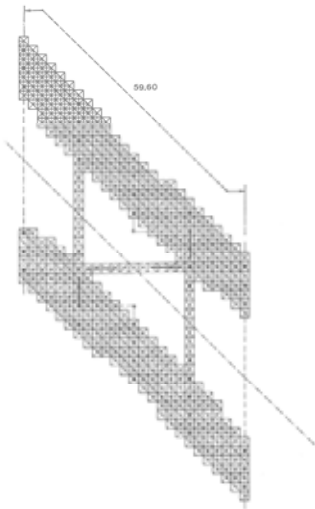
(dcha.). Planta de situación. ([s.n.] 1970e)
